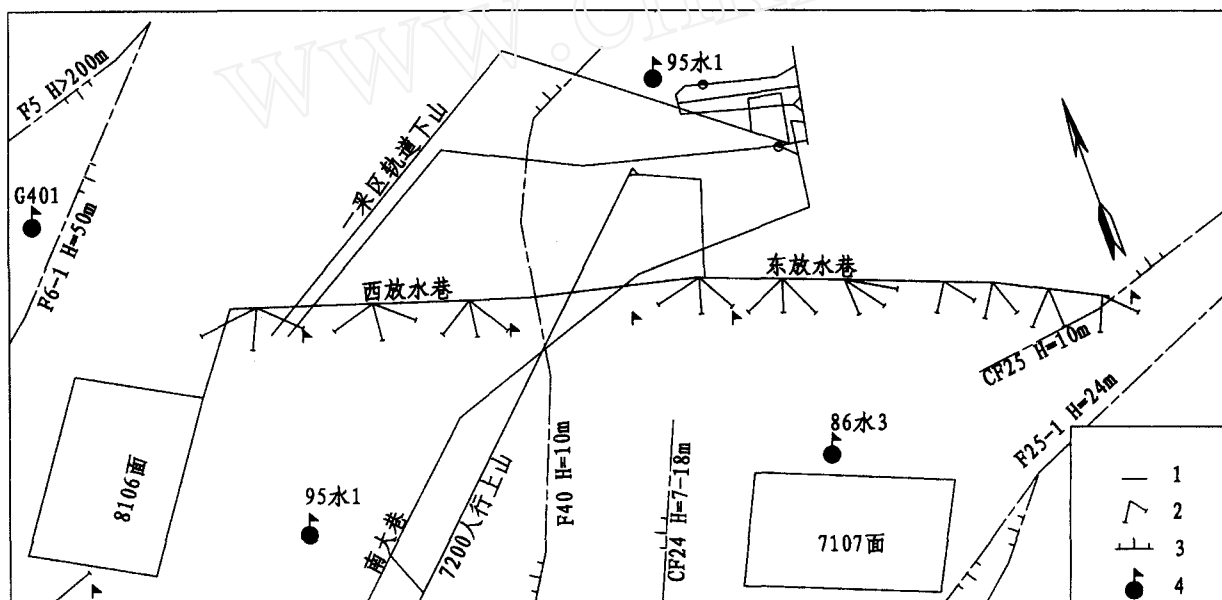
肥城矿区查庄矿联合放水试验工程布置平面图
